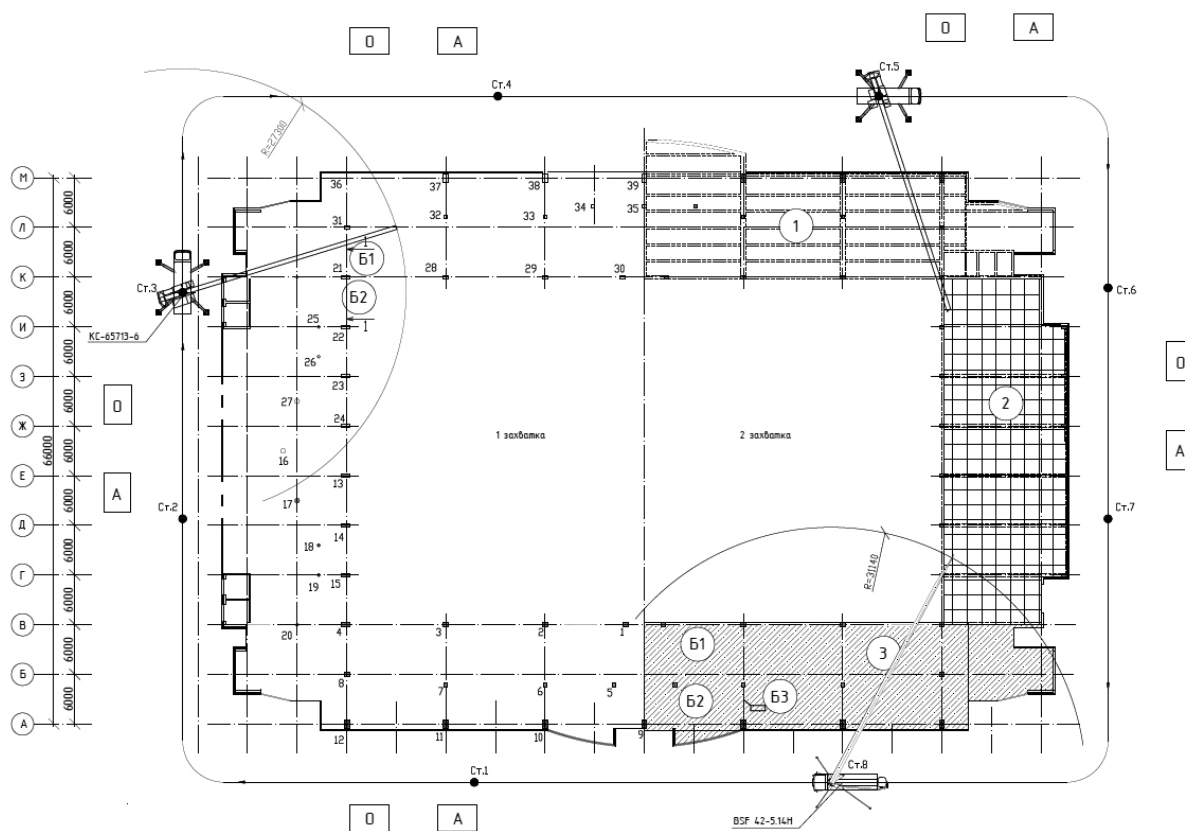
Схема бетонирования этажа здания Дворца спорта
